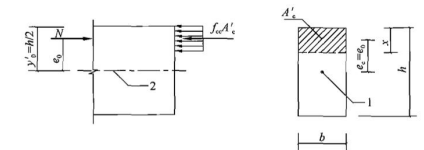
矩形截面的素混凝土受压构件受压承载力计算
